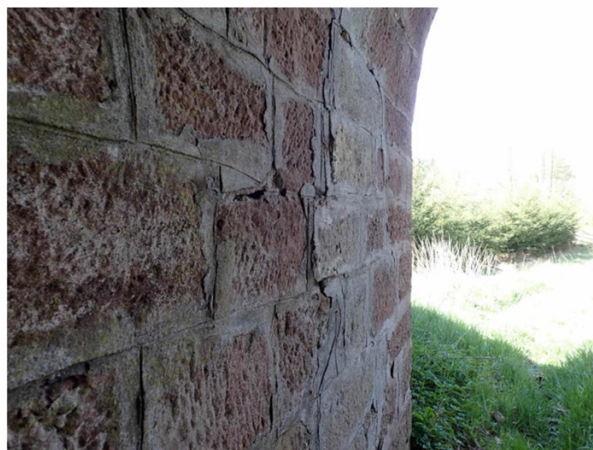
O 01, 1,55 m zleva detail boulení a vysunu kvádrů.
